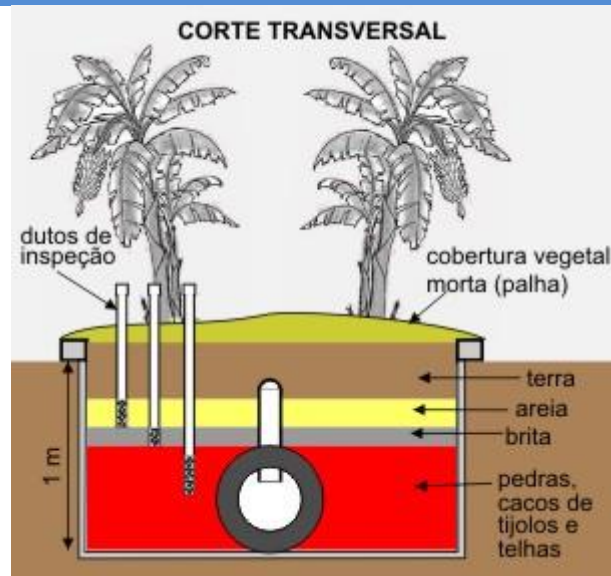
Esquema de Construção do Tanque de Evapotranspiração –
